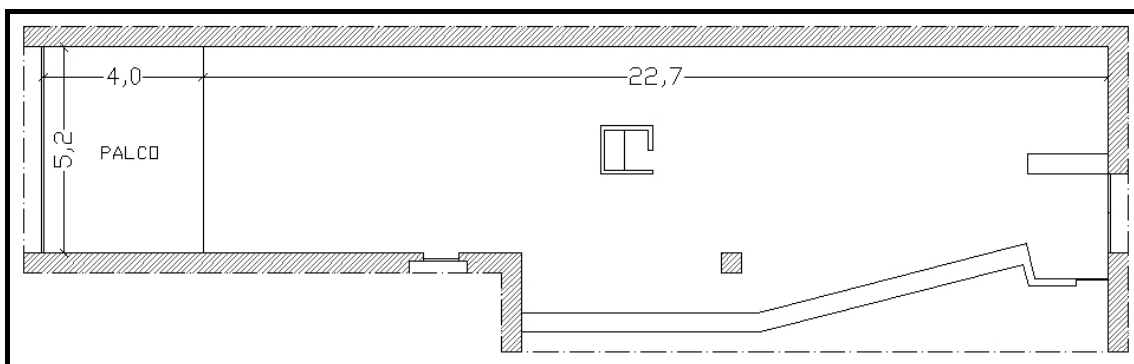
Planta do Bar-Concerto Onda Jazz
